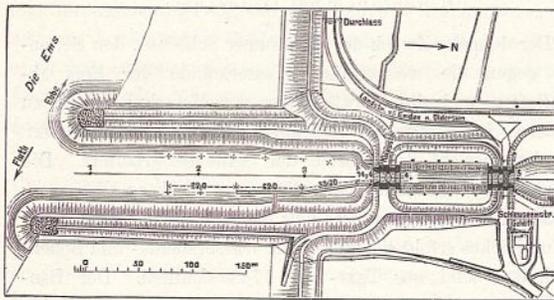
Lageplan der Oldersumer Seeschleuse.
